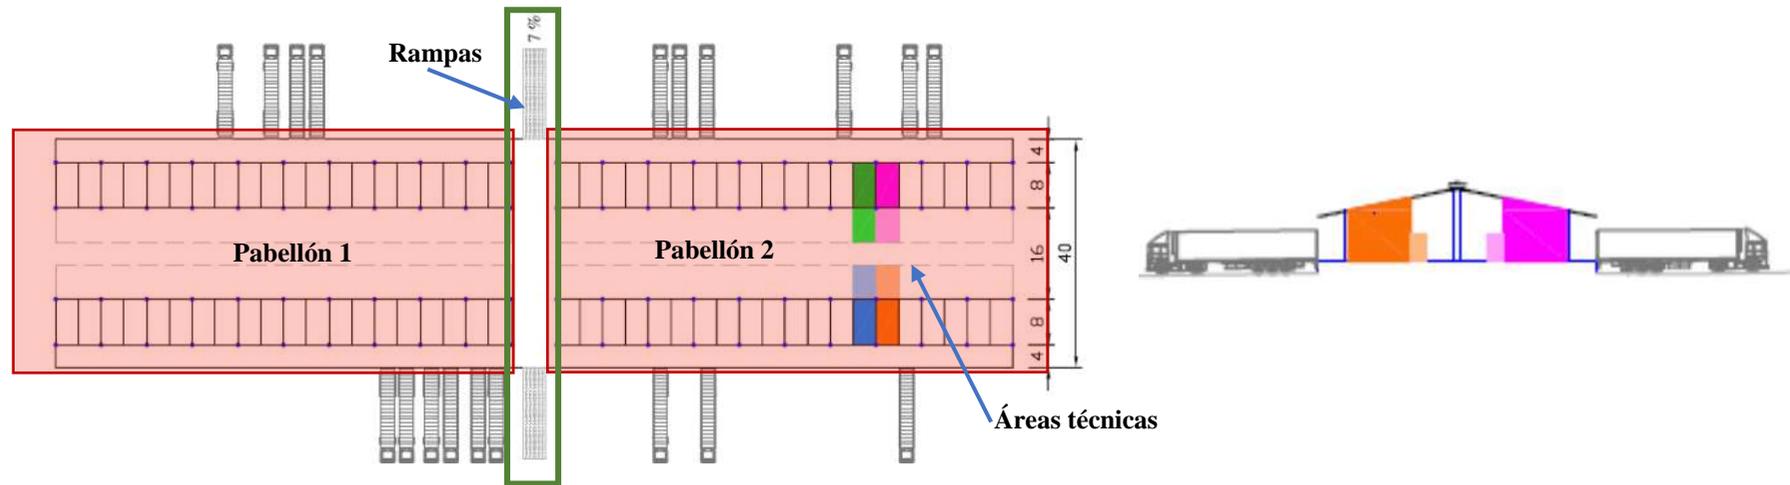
Esquema interno de un pabellón tipo. Fuente: editado sobre imagen de Proyecto del Mercado Mayorista de Lima
